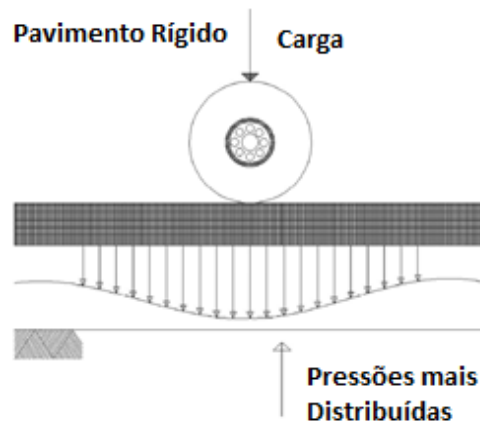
Distribuição de tensões nos pavimentos rígidos (fonte: Jacob, 2017).
